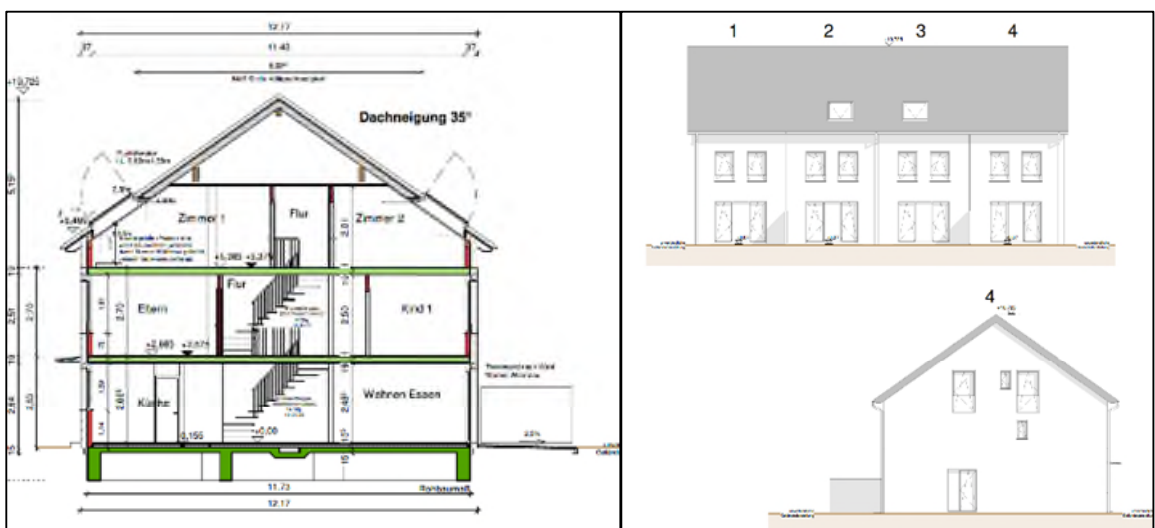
Bauungskonzept: geplante Bebauung / Haustypen (Werner Wohnbau GmbH & Co. KG)
